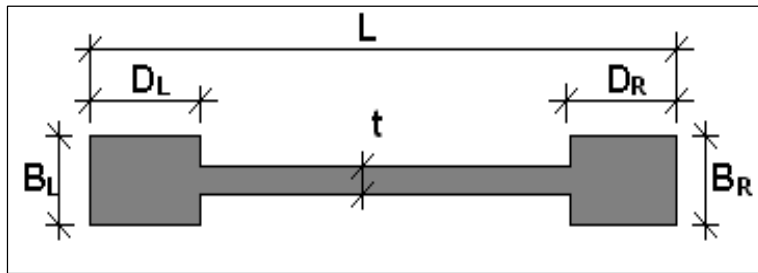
Modelo geométrico del muro estructural ubicado en la zona de las escaleras.
